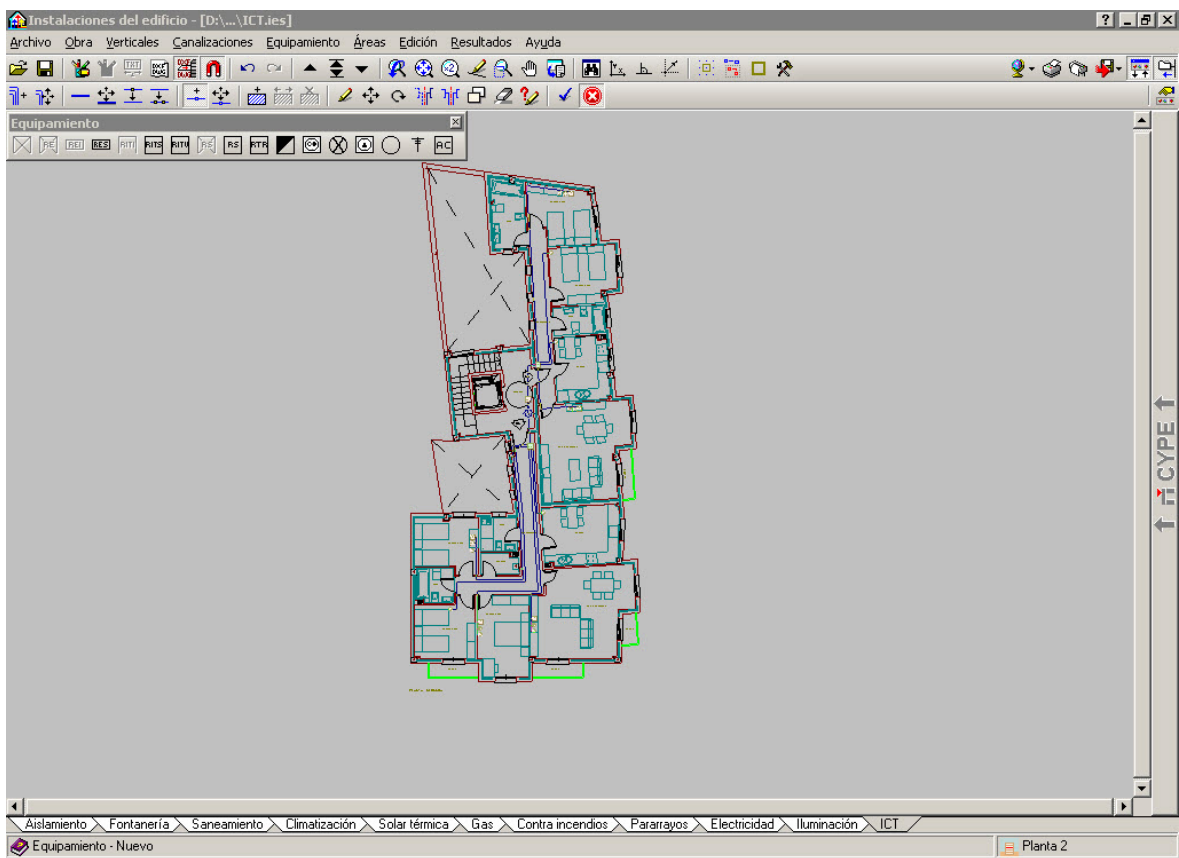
Instalación ICT planta segunda (pre-dimensionado)
